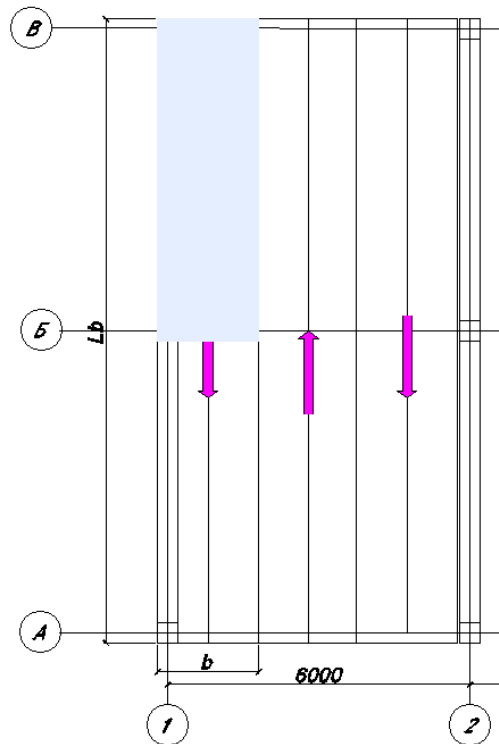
Схема вкладання бетонної суміші без повернення до початку першої смуги
